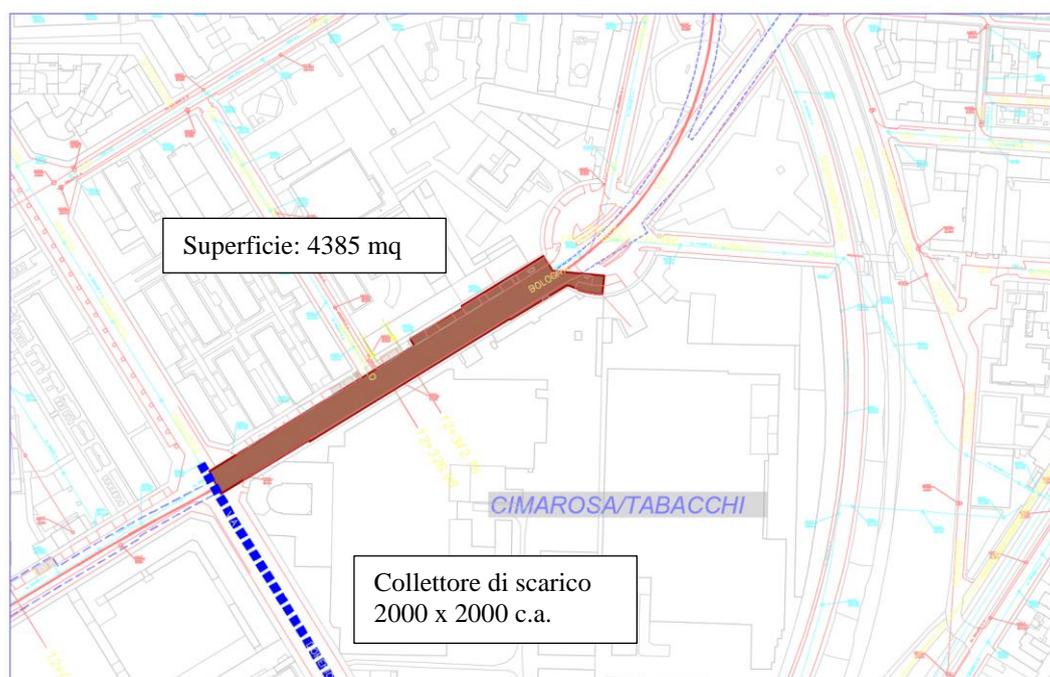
Aree di cantiere – Stazione Cimarosa / Tabacchi – UNICA FASE
